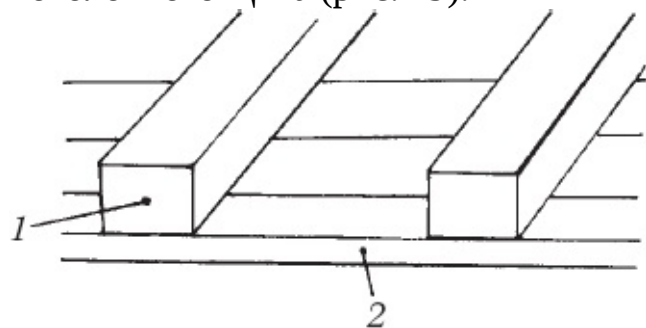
Конструкция потолочного щита: 1 – балка; 2 – доски щита
